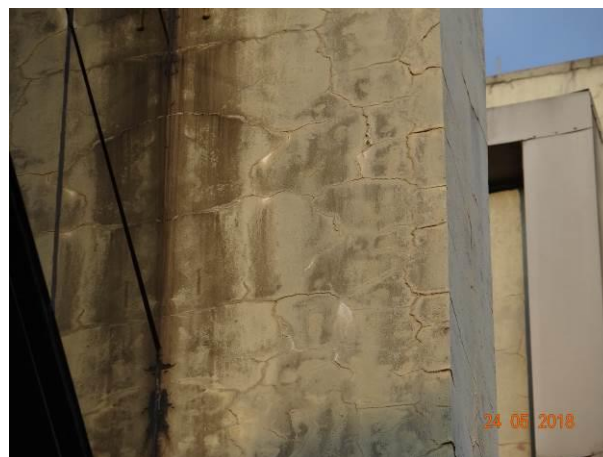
Vista dos pilares na Fachada Oeste.
